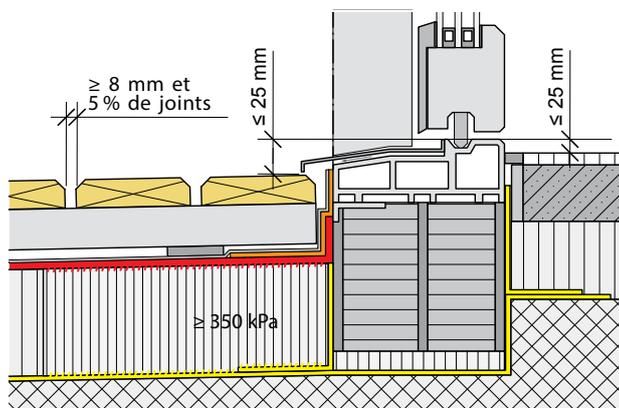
Seuil de porte coulissante et caillebotis en bois; hauteur du seuil max. 25 mm
